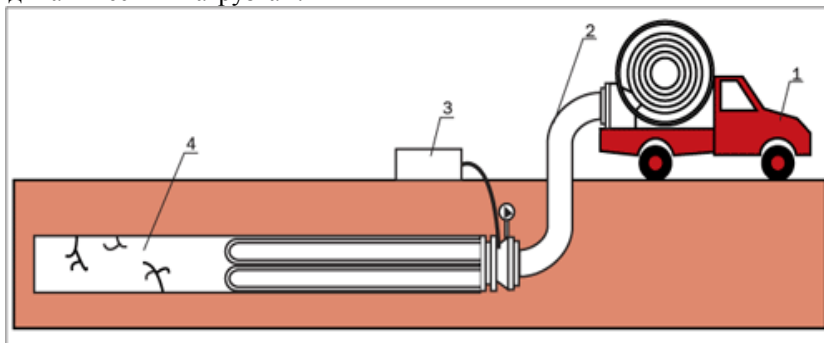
Схема нанесения внутреннего защитного покрытия: 1 – автомобиль с оборудованием для установки рукава; 2 – полимерный рукав; 3 – компрессор; 4 – санируемый трубопровод
